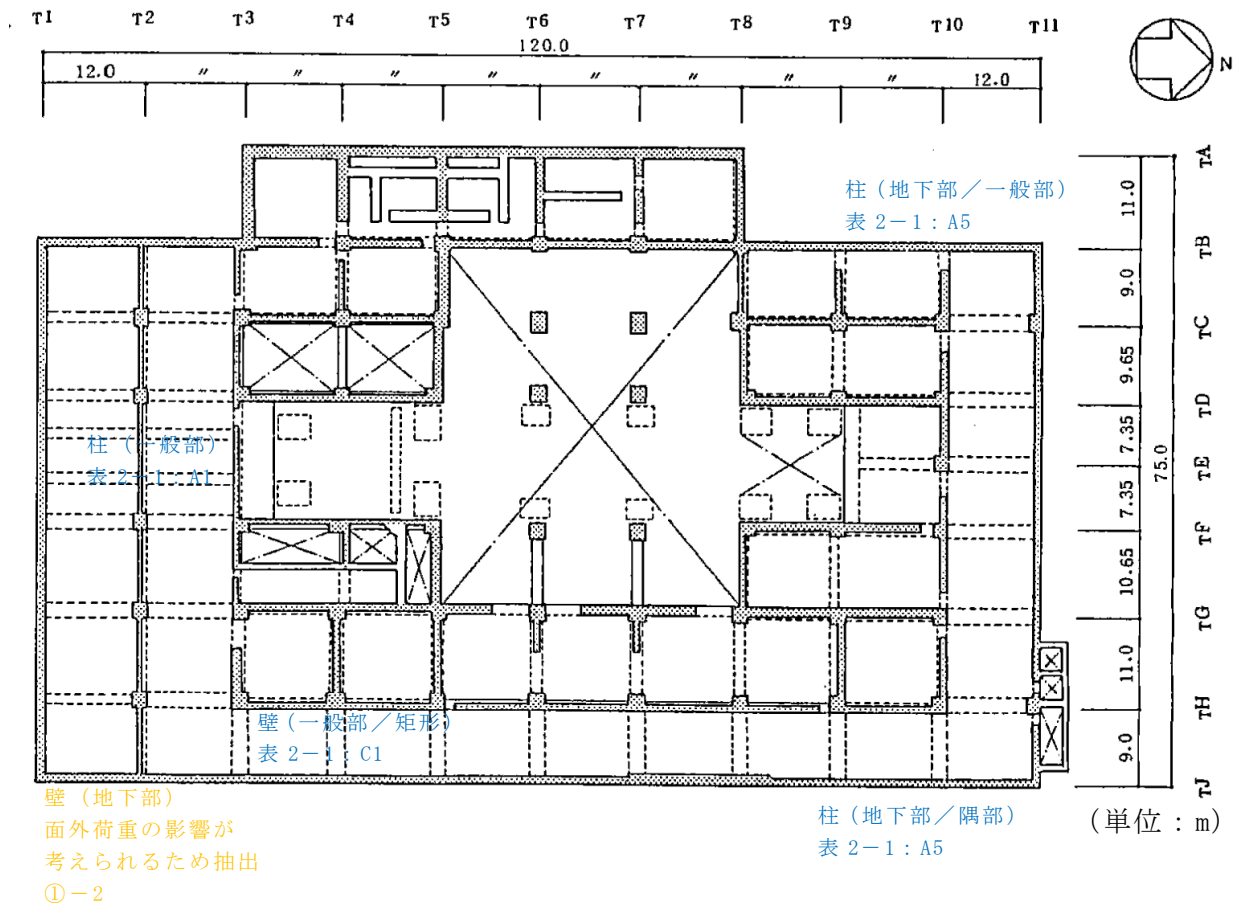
5号機タービン建屋の概略平面図 (B1F, T.M.S.L. +4.9m) (2/5)
